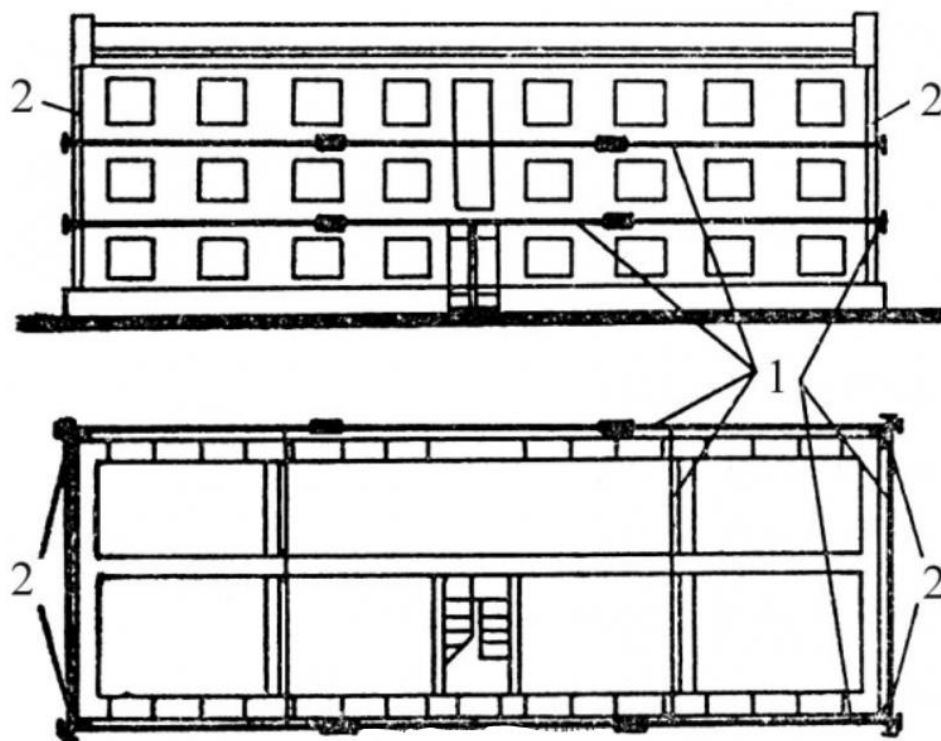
Скріплення будівлі напруженими сталевими тяжами на рівні перекриття: 1 – тяжі; 2 – кутники
